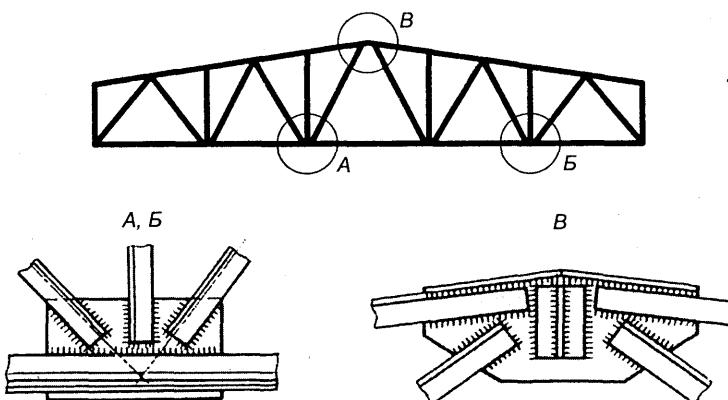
Сварка фермы и ее узлов A, B, B'
